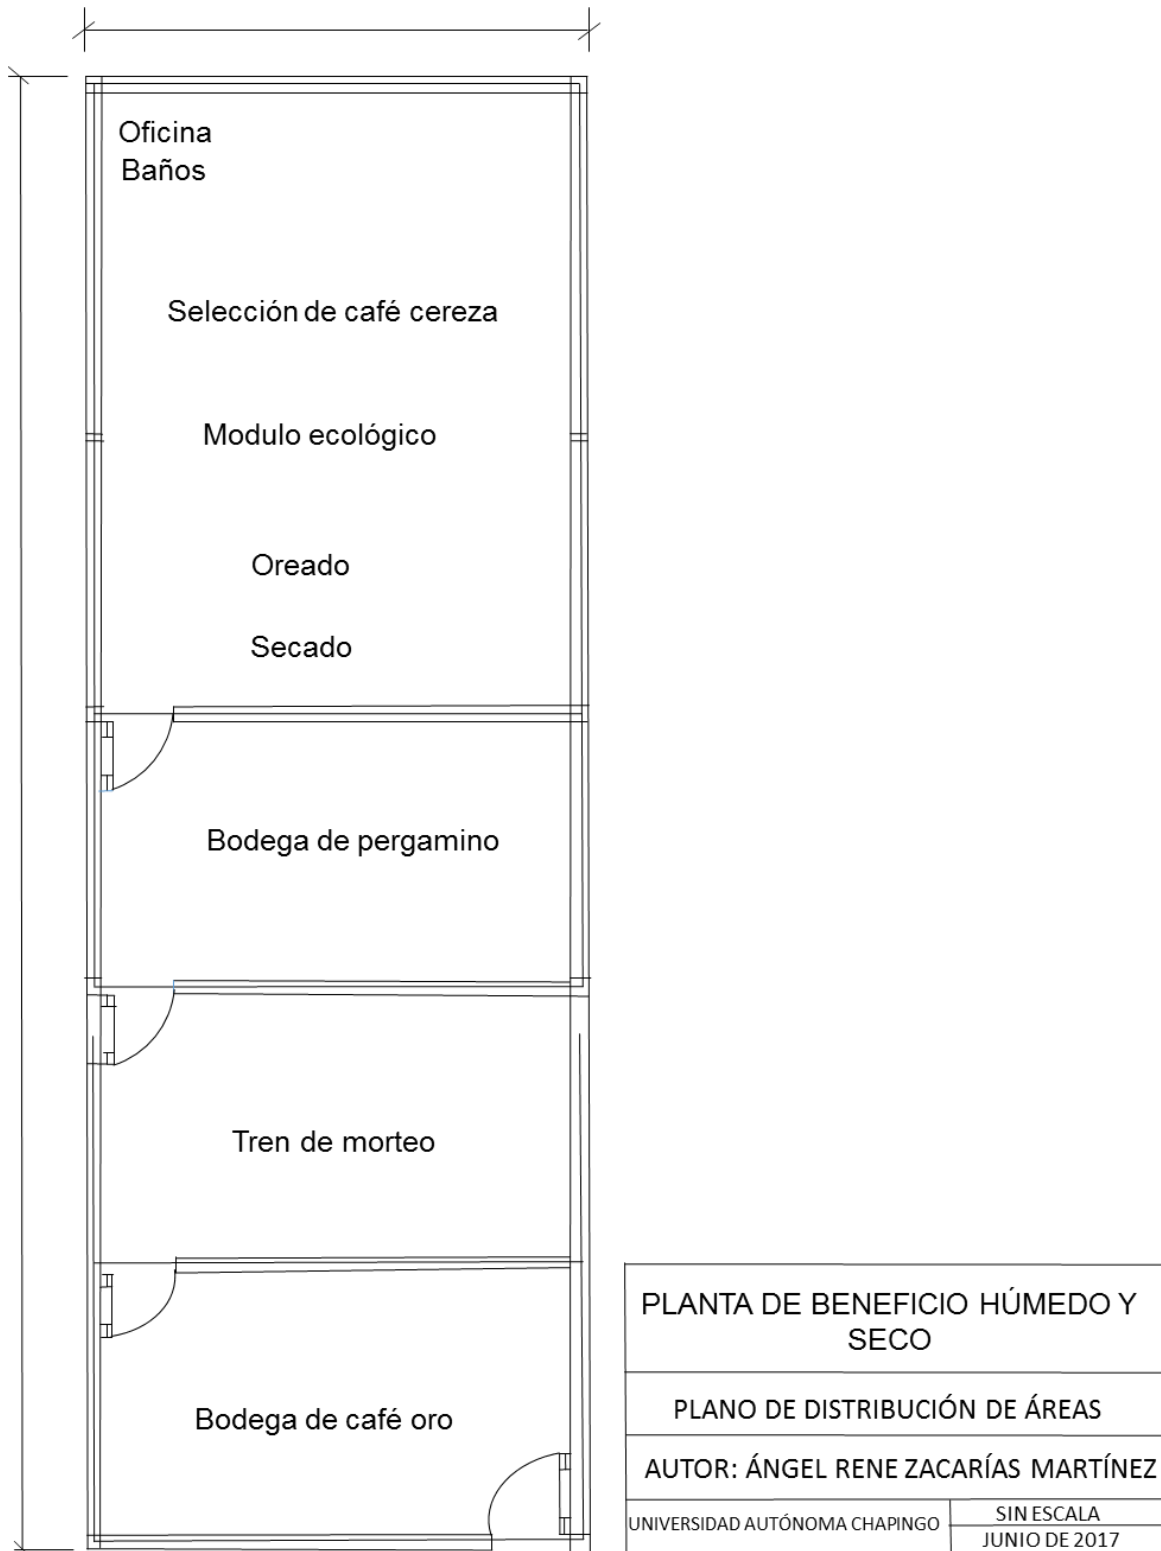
Plano de distribución de áreas de la planta beneficiadora
